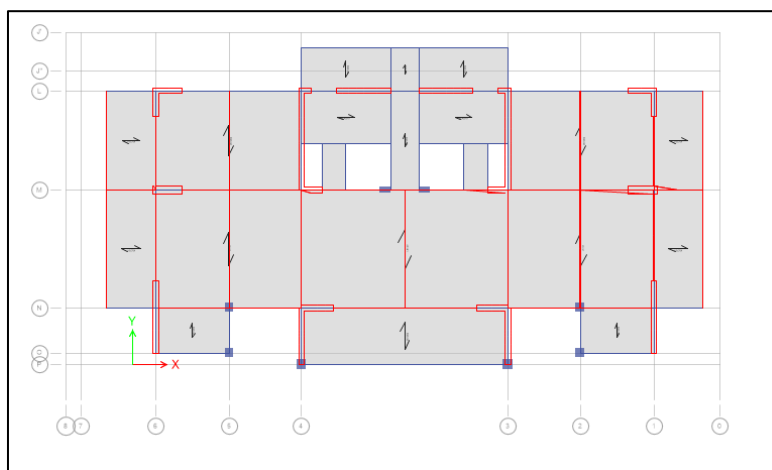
Distribución de la fachada y las paredes internas en la planta típica.
